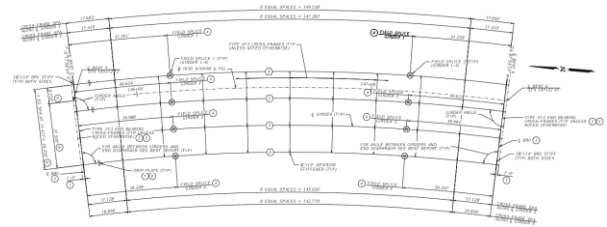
Disposición en planta de las vigas y marcos transversales del vano 6 del puente 409.
